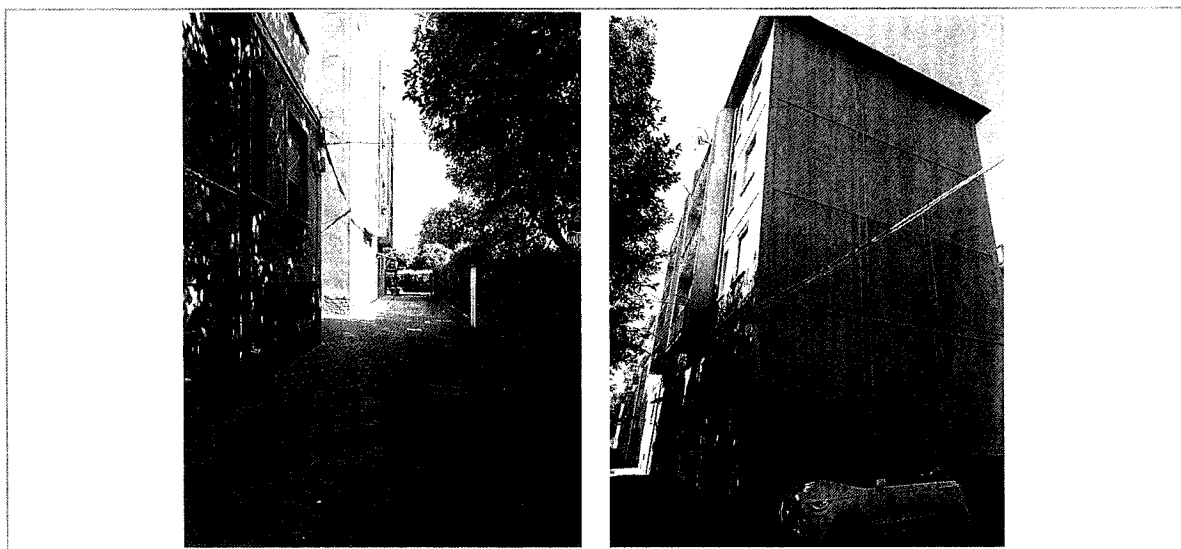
5: vista fabbricato e accesso dalla strada
